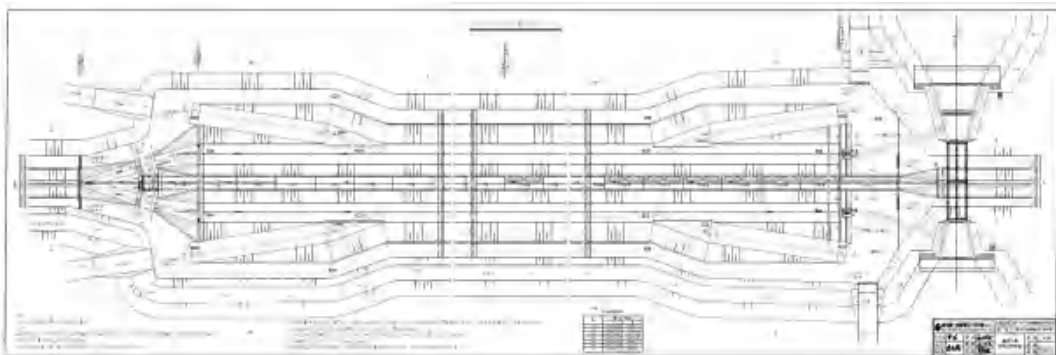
高泉干渠、双河干渠沉砂池平面布置示意图（双池）
